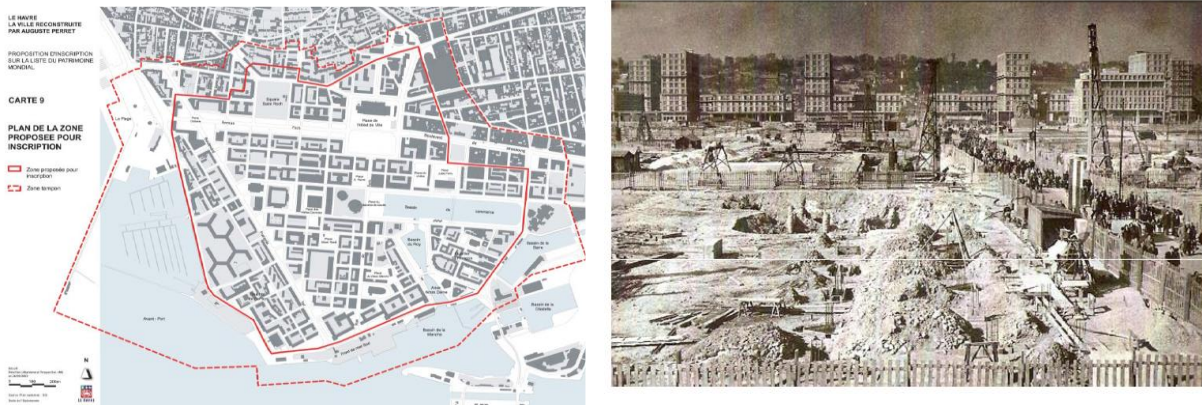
(a) le plan du centre reconstruit - (b) les phases de travaux en cours (fondations à superstructure)
